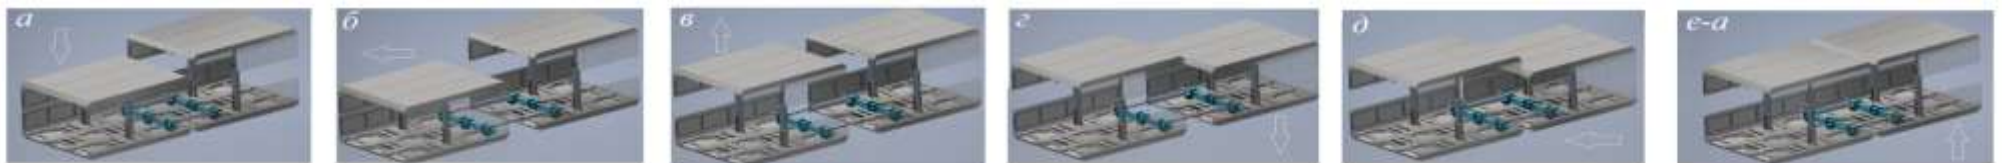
Схема перемещения шагающей крепи проходческого комплекса: а – перекрытие передней части опускается; б – передняя часть выдвигается на забой; в – перекрытие передней части поднимается до упора в кровлю; г – перекрытие задней части опускается; д – задняя часть передвигается к передней части; е – перекрытия задней части поднимается до упора в кровлю
